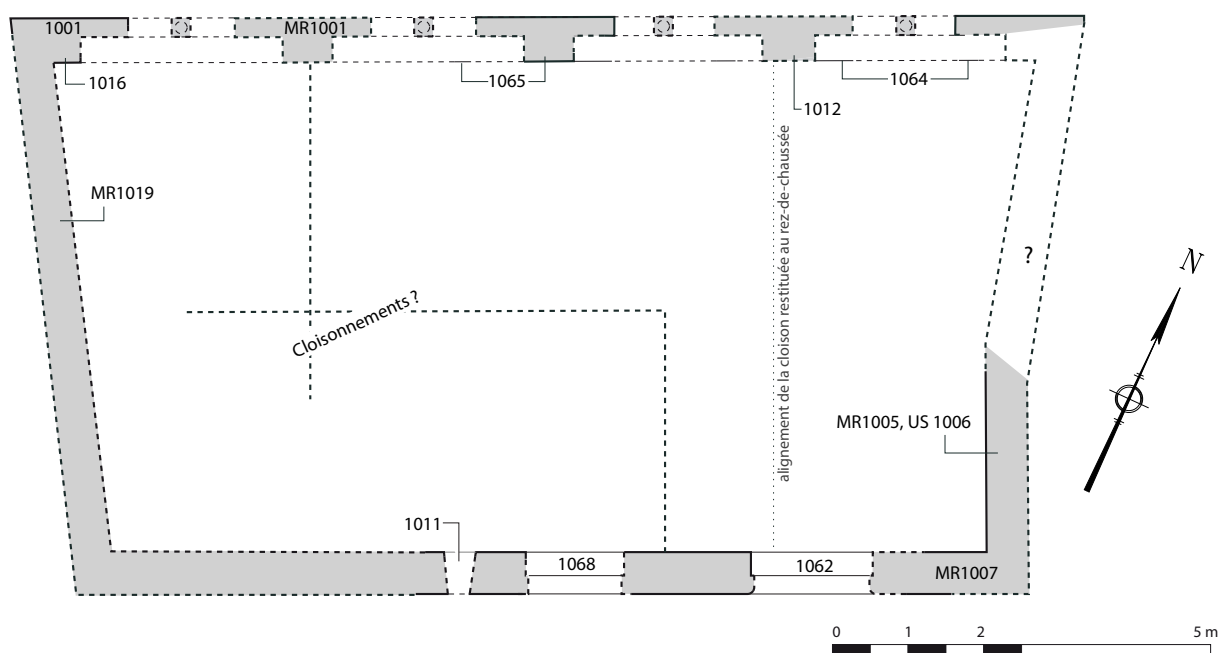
Plan des vestiges et restitution de la phase 1 au premier étage. Dessin O. Maufra/Inrap. Fond de plan : SARL NDA.
